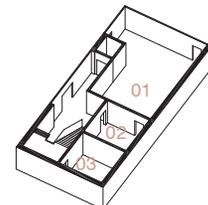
3D Darstellung, Grundrisse Kutscherhaus
